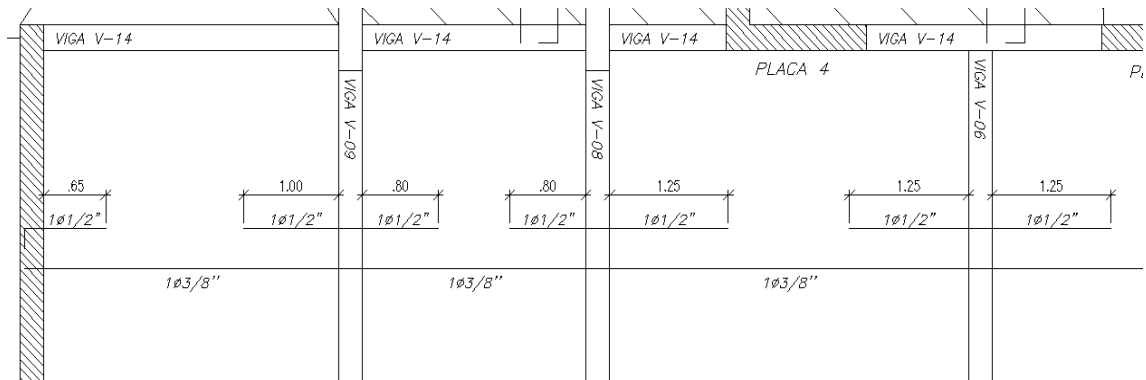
Esquema final del armado del refuerzo longitudinal de la vigueta
